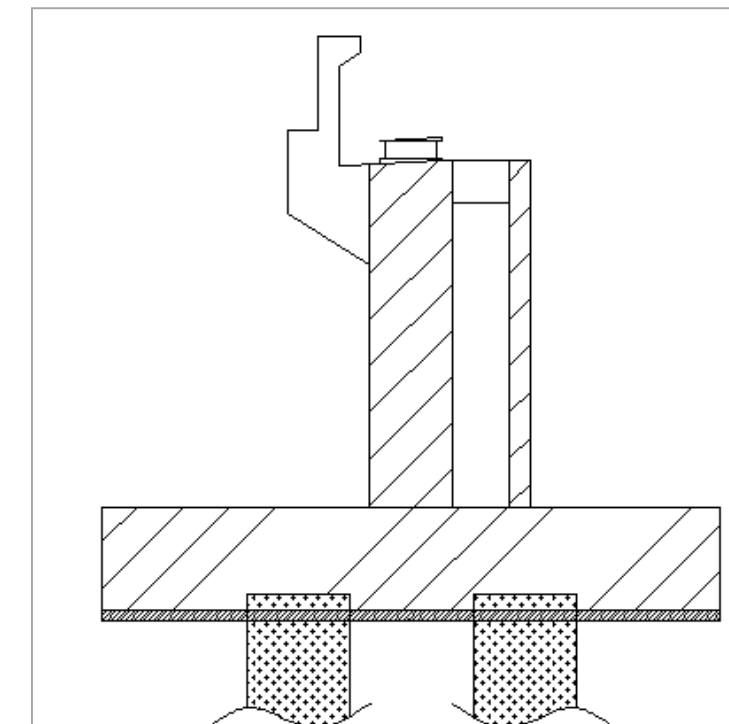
Sección indicativa de las zonas a calcular. Fuente: Elaboración propia con AutoCAD.
